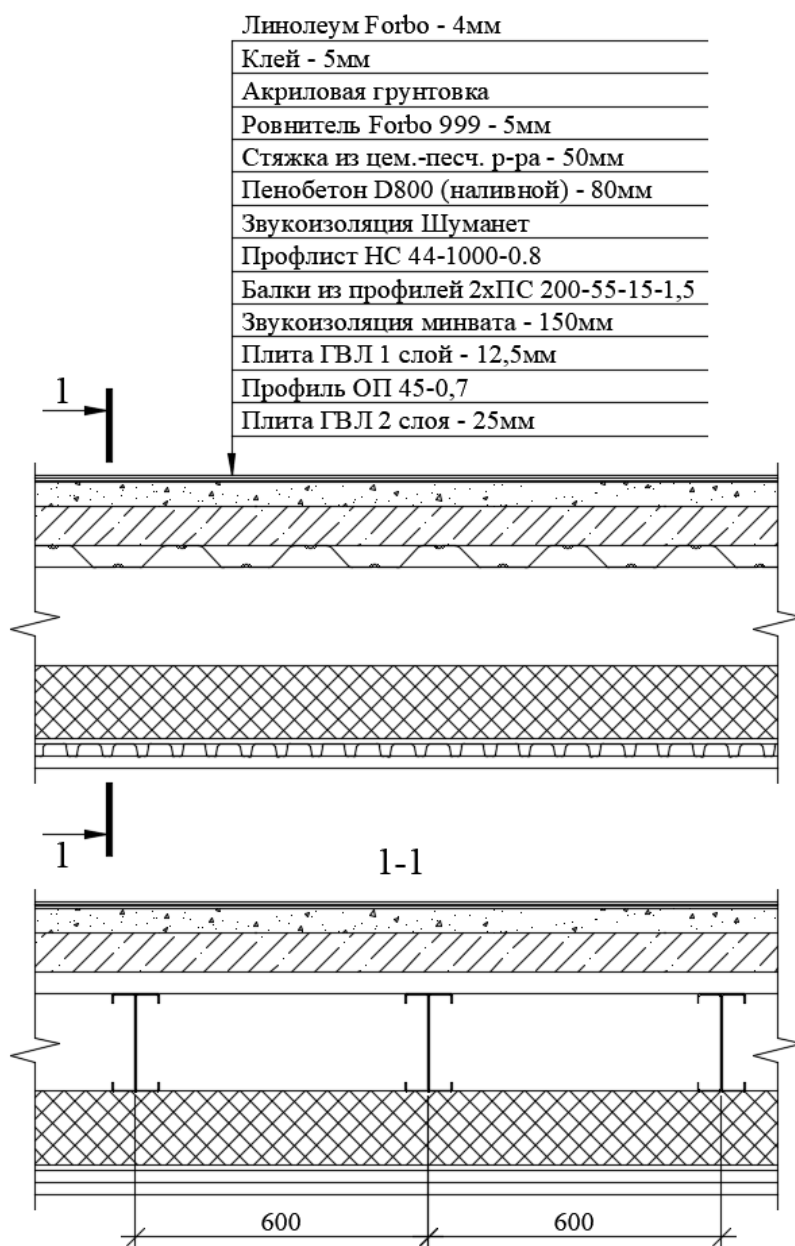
Сечения по конструкции перекрытия
